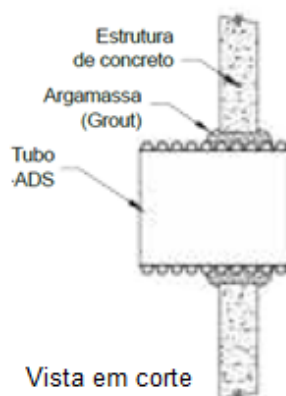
Conexão hermética entre tubo e estrutura de concreto
